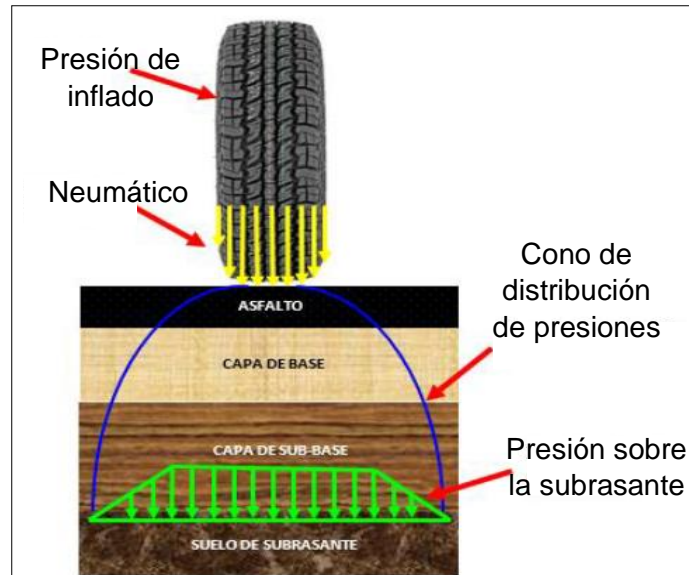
Estructura del pavimento asfáltico y transferencia de carga [33].
